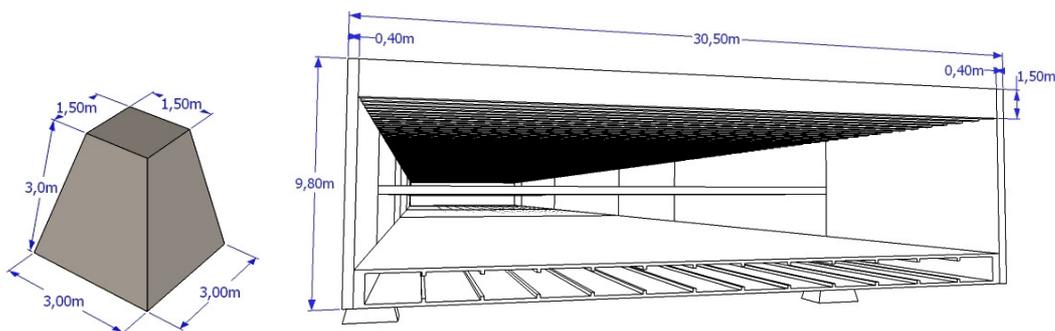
Desenho esquemático da planta e da elevação do Pavilhão da Gameleira (Fonte: (CUNHA, SOUZA e LIMA, 1996))
